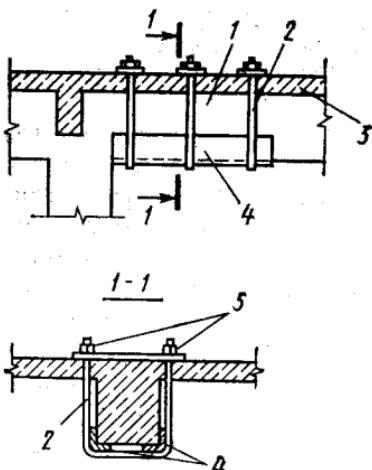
Усиление балок по наклонному сечению хомутами:
